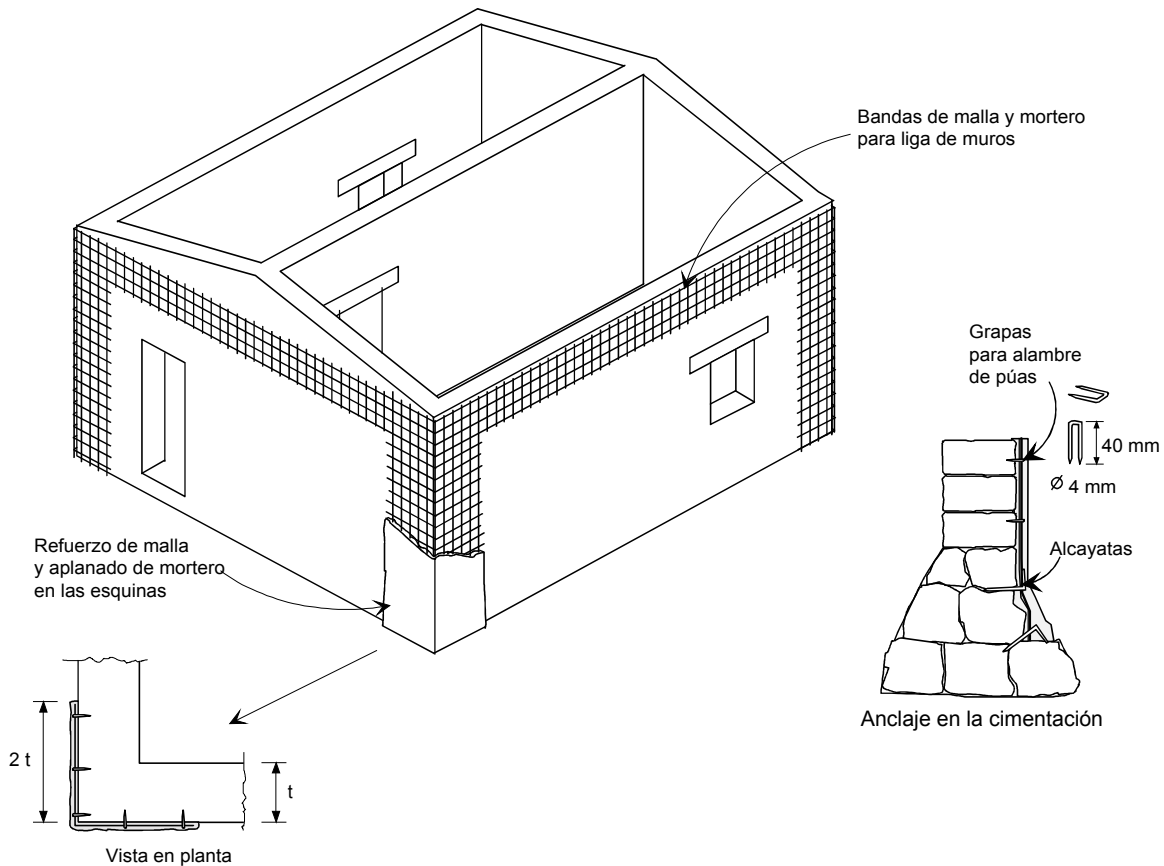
Refuerzo de una vivienda de mampostería simple con bandas metálicas en los bordes de los muros (Flores y otros, 2001)
